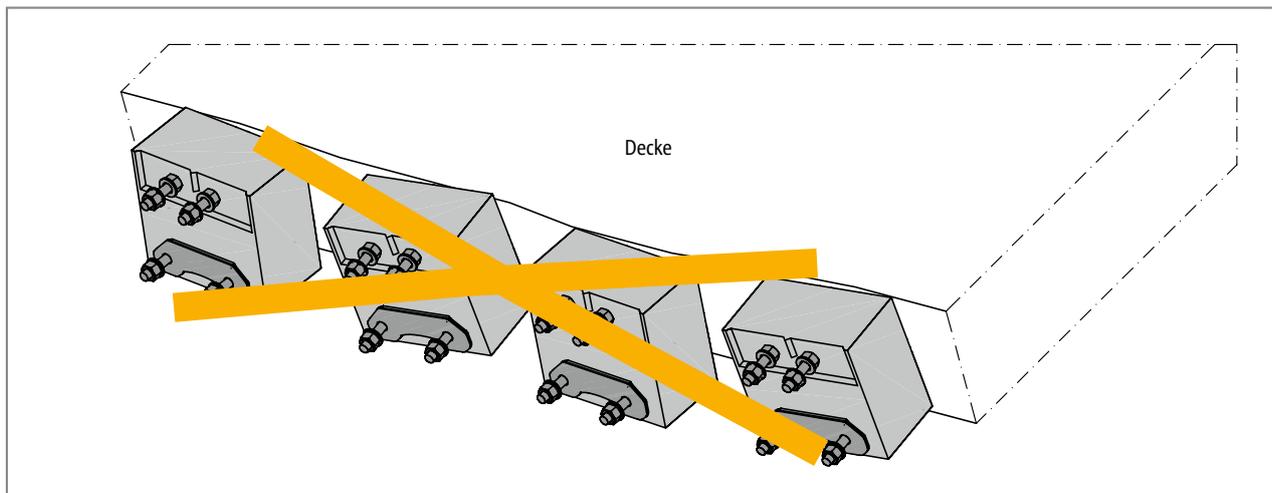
Schöck Isokorb®: Verdrehte und verschobene Elemente durch mangelhafte Lagesicherung während des Betonierens
